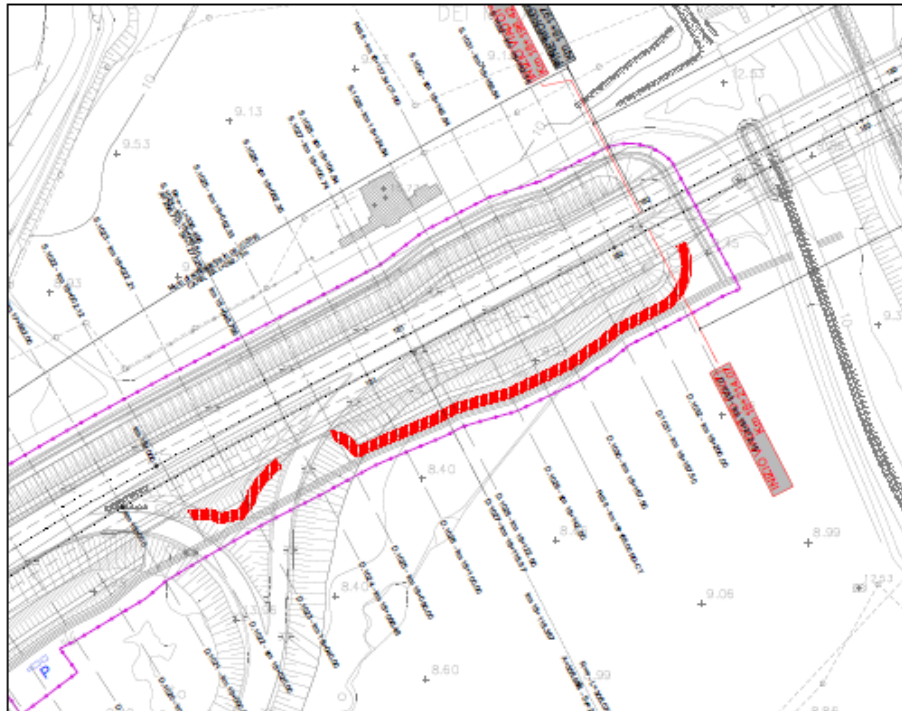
protezione rilevato da km 18+020 a km 18+212.
